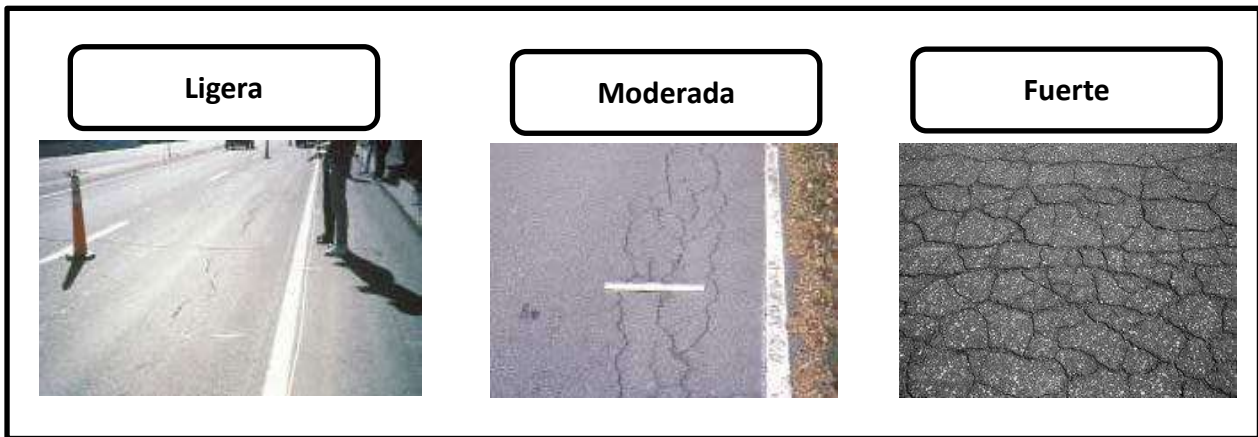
Progreso de la Fisuración por Fatiga.
